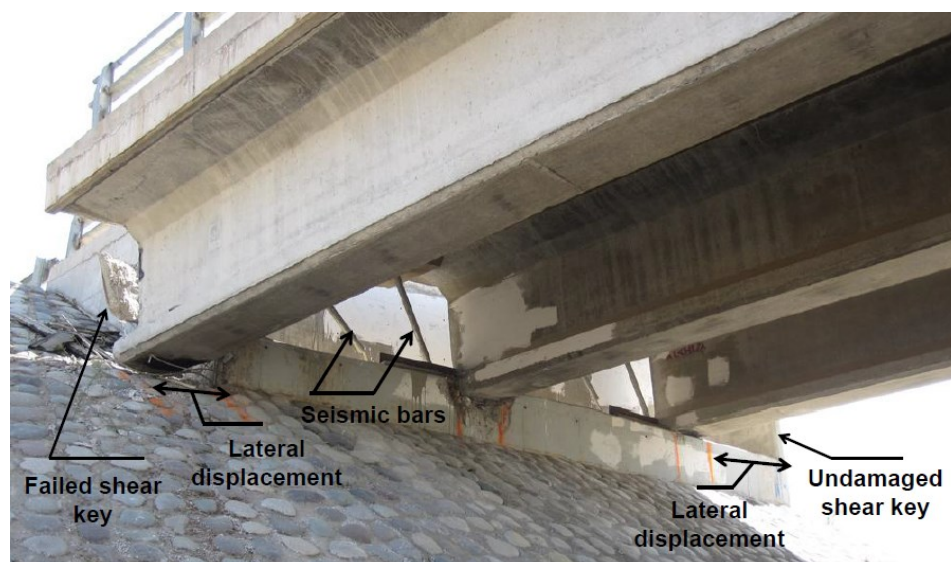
Vista inferior da entrega do tabuleiro ao apoio (Yashinsky, et al., 2010).
